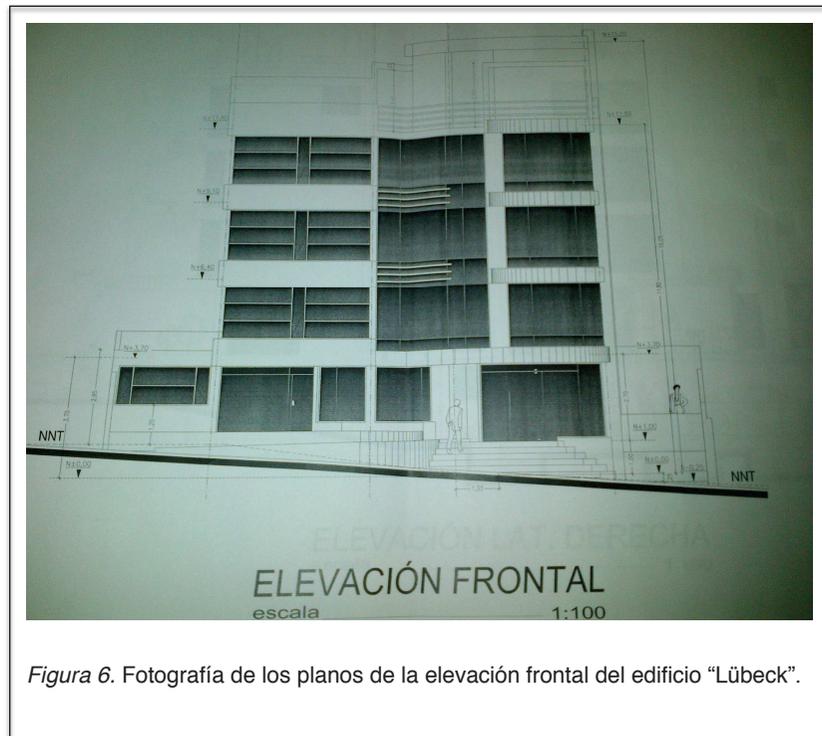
Fotografía de los planos de la elevación frontal del edificio “Lübeck”.
